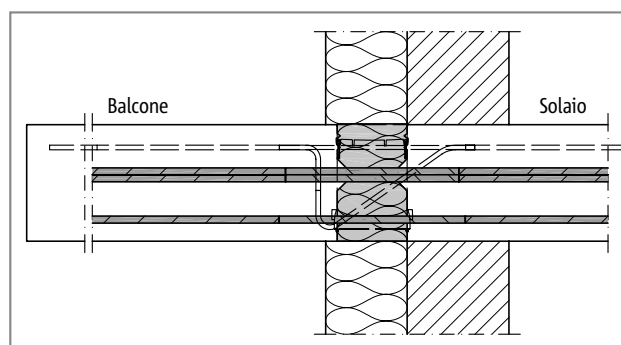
Schöck Isokorb® tipo KXT, EQXT: sistema isolamento a cappotto
